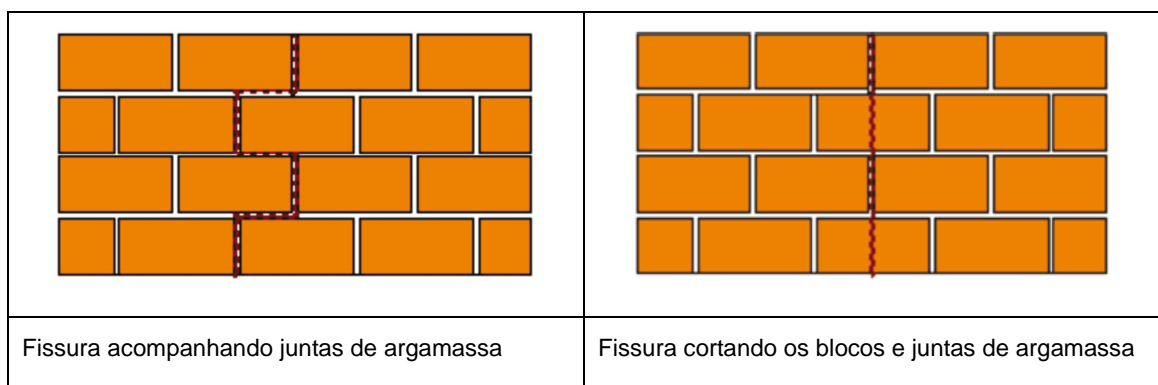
Fissuras verticais acompanhando juntas e cortando o bloco.
